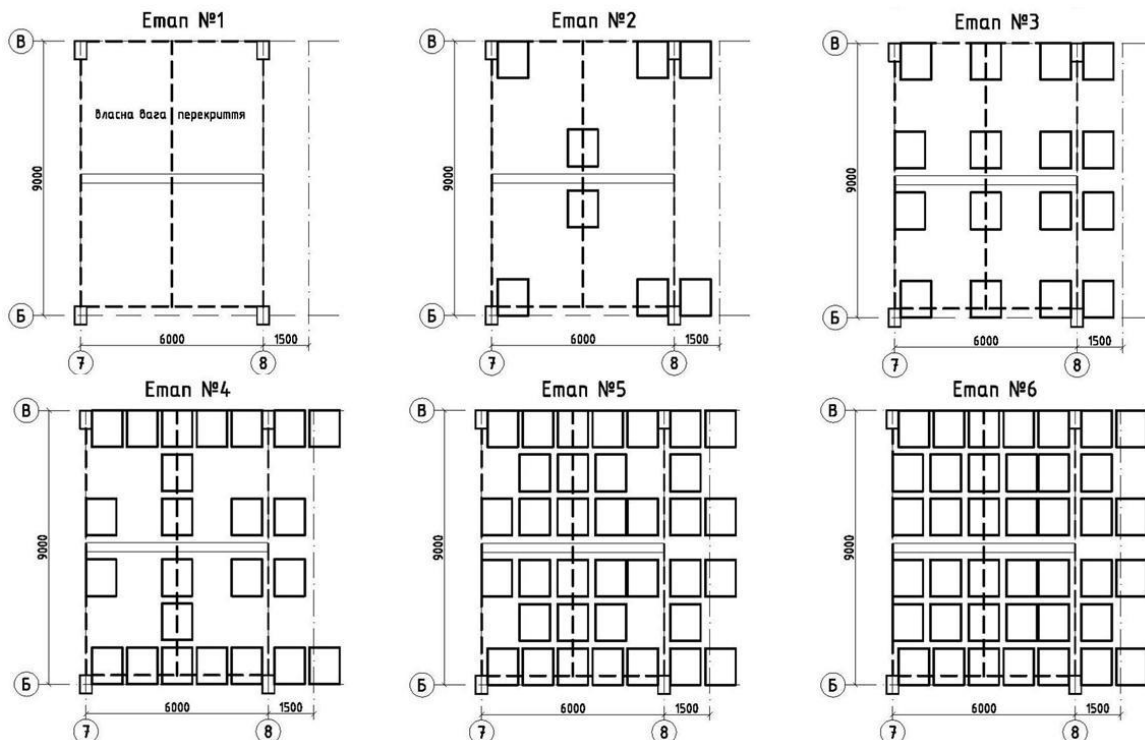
Схема розташування ділянки випробуваного сталезалізобетонного перекриття
